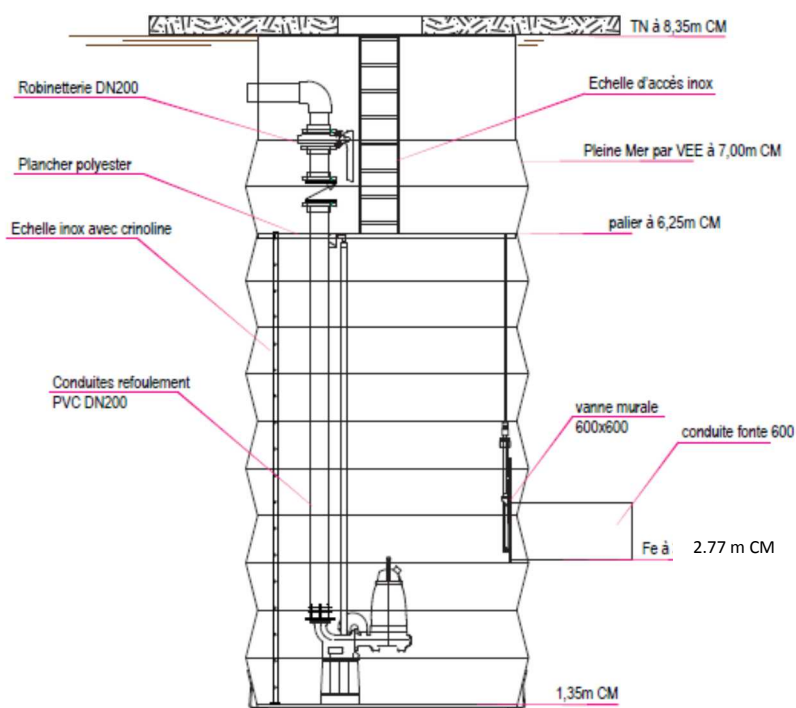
Coupe type du puits existant et vue de l'ouvrage en surface
